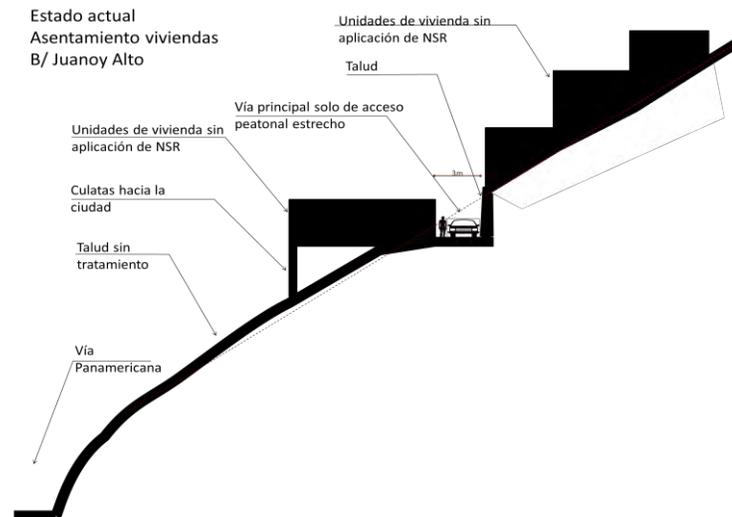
Estado de Asentamiento de Viviendas B/Juanoy Alto.
